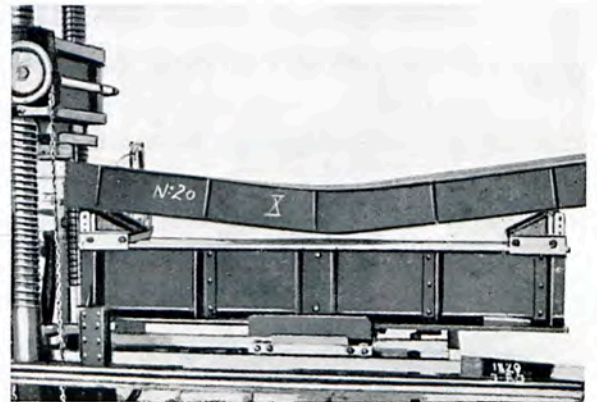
Essai d'une poutrelle munie de 5 raidisseurs.
